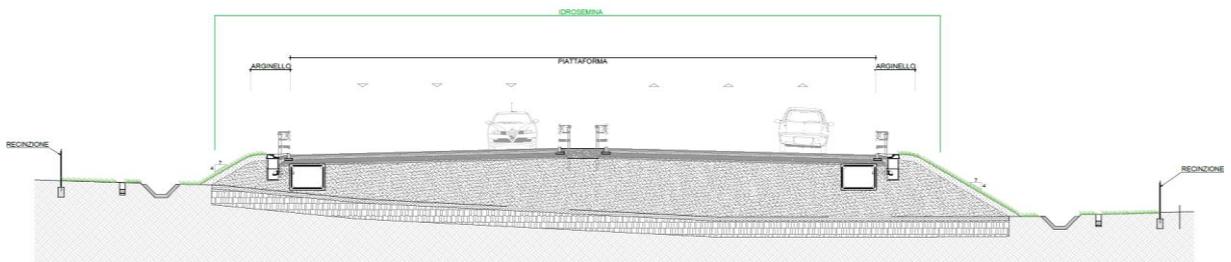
Esempio di inerbimento rilevato e trincea stradale
